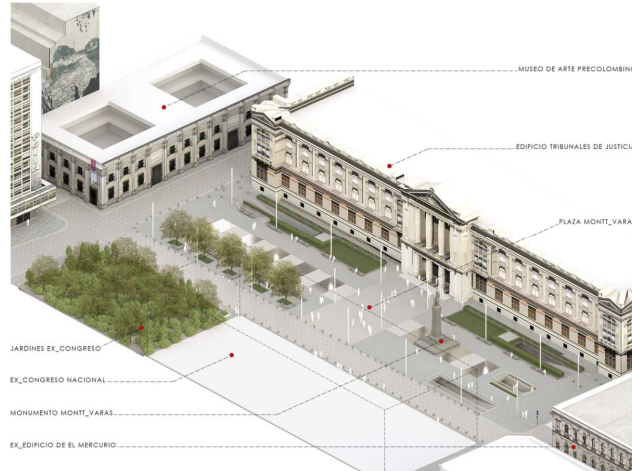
Vista 3D de la propuesta de la plaza y edificios que la rodean. Fuente: Imagen por PLAN Arquitectos, 2015. Publicada en Plataforma Arquitectura.
